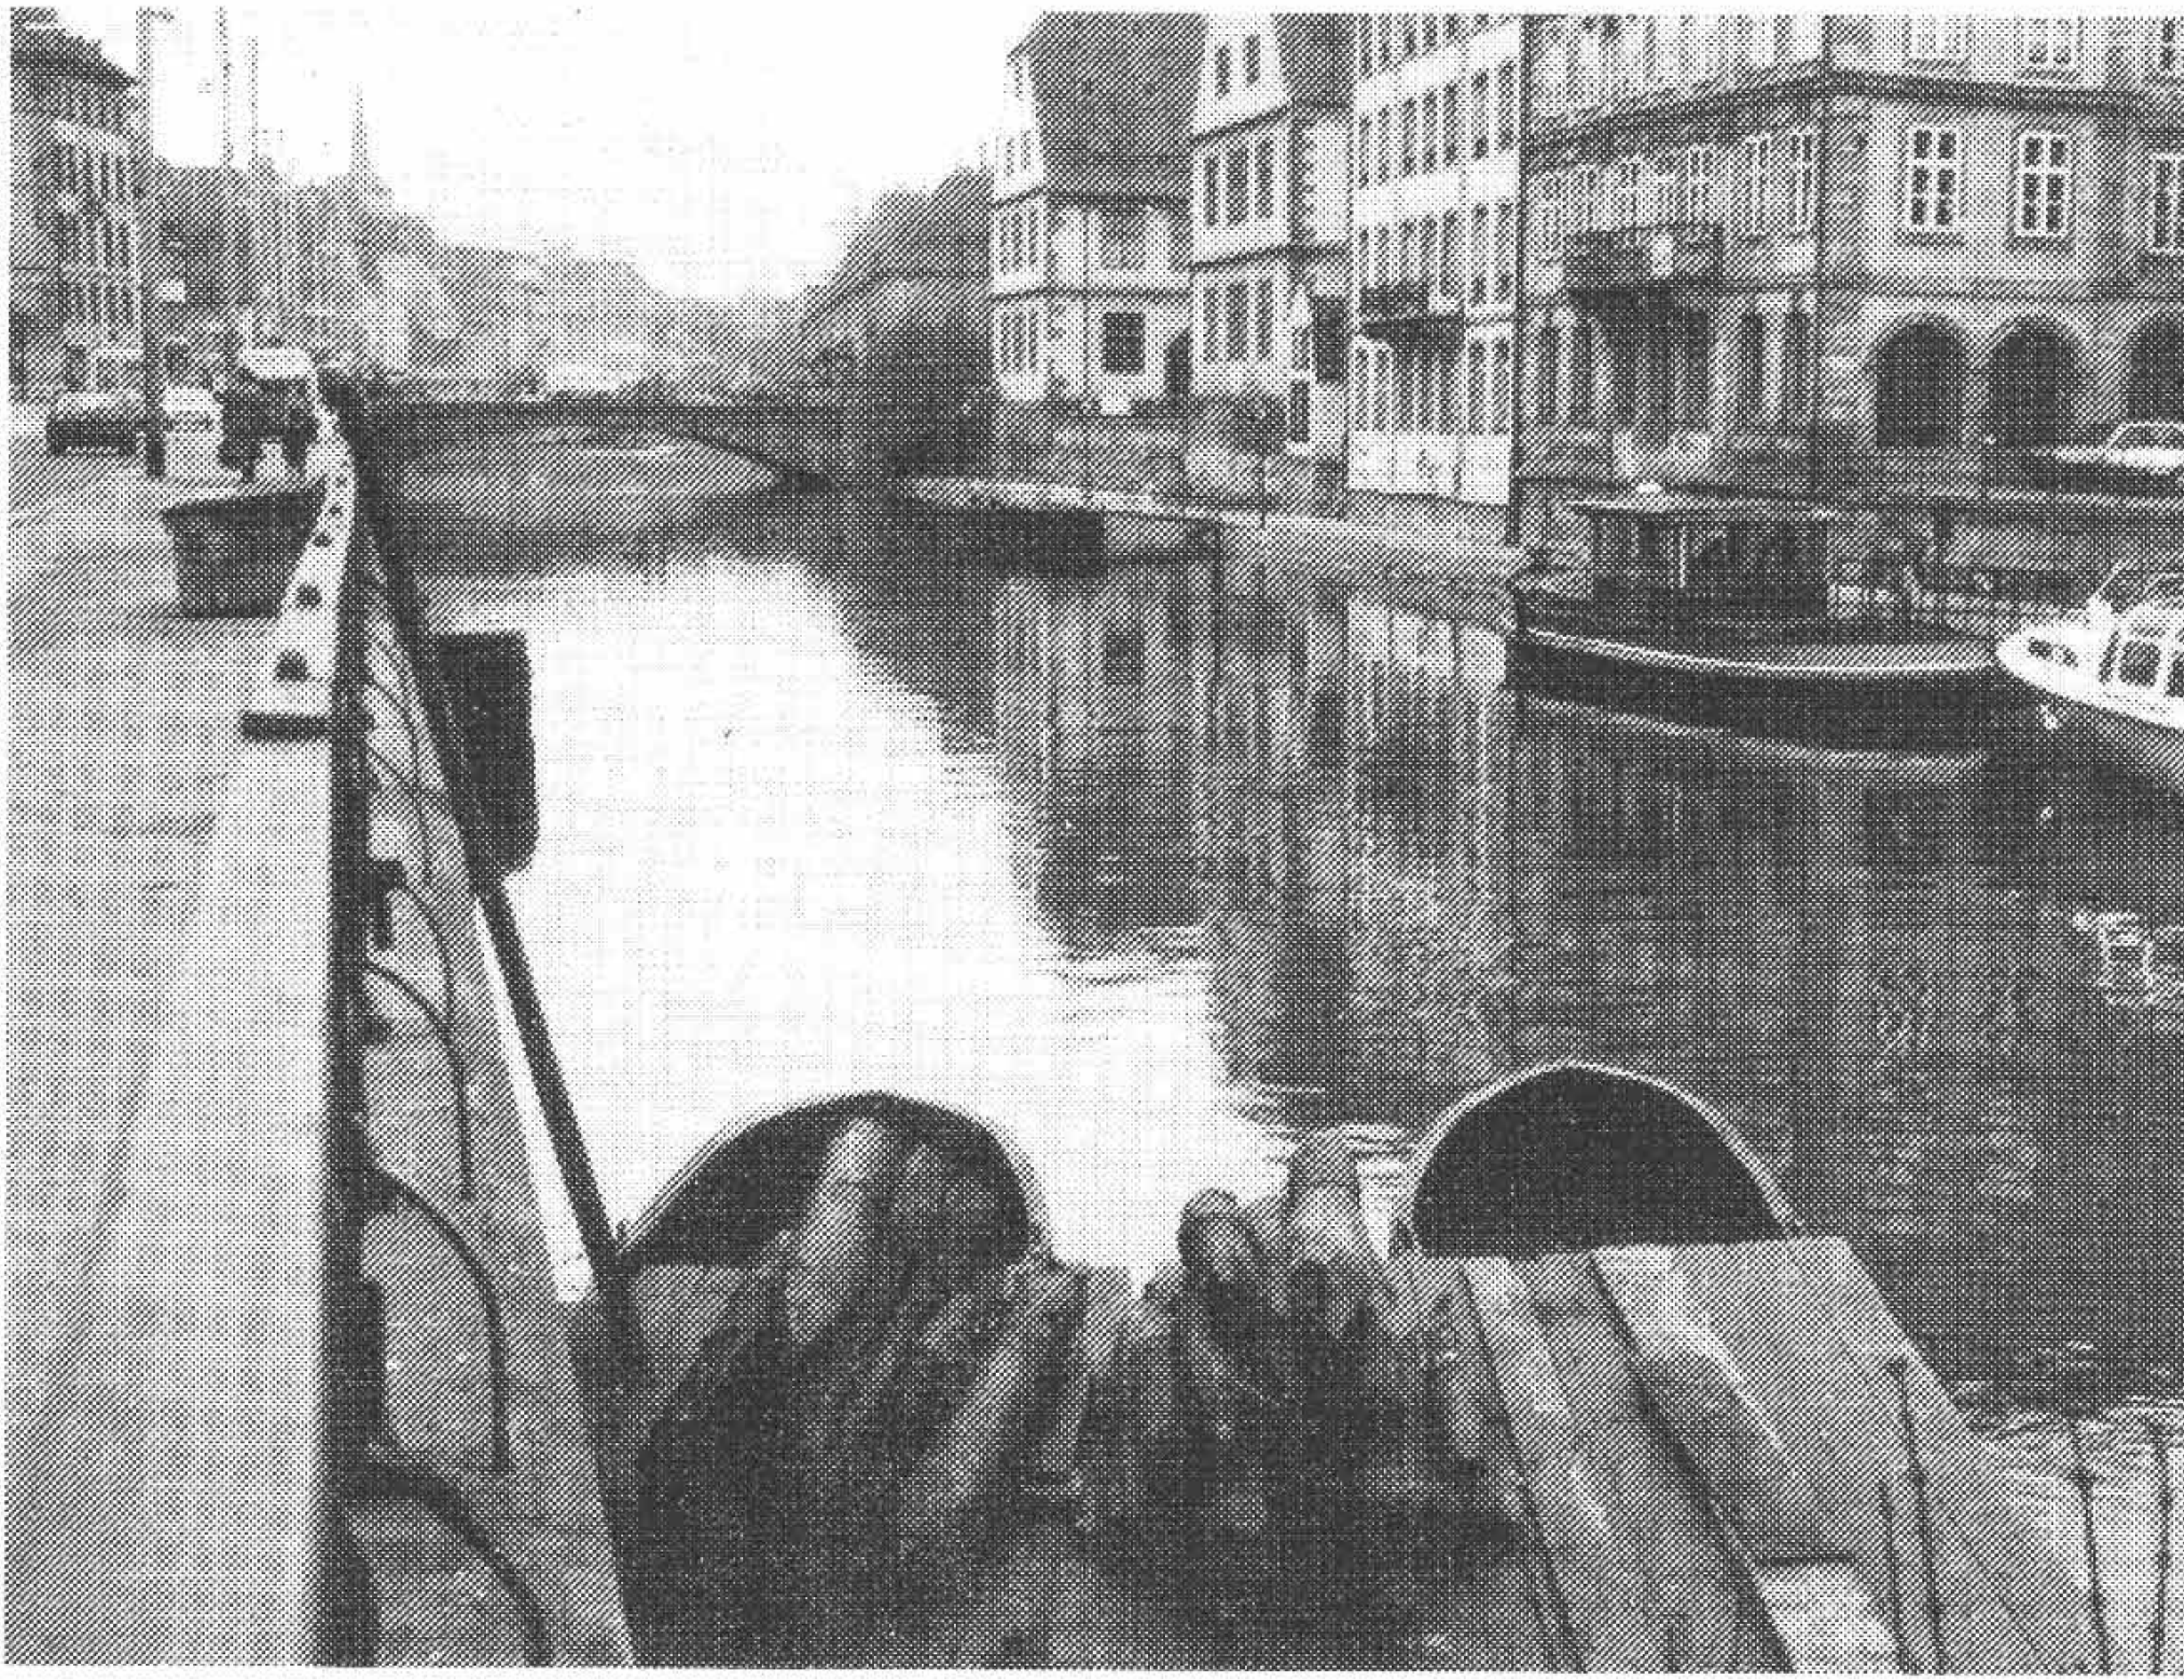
Quai des Bâteliers, 1988. Pieux de fondation (ou du bâtardeau?)
